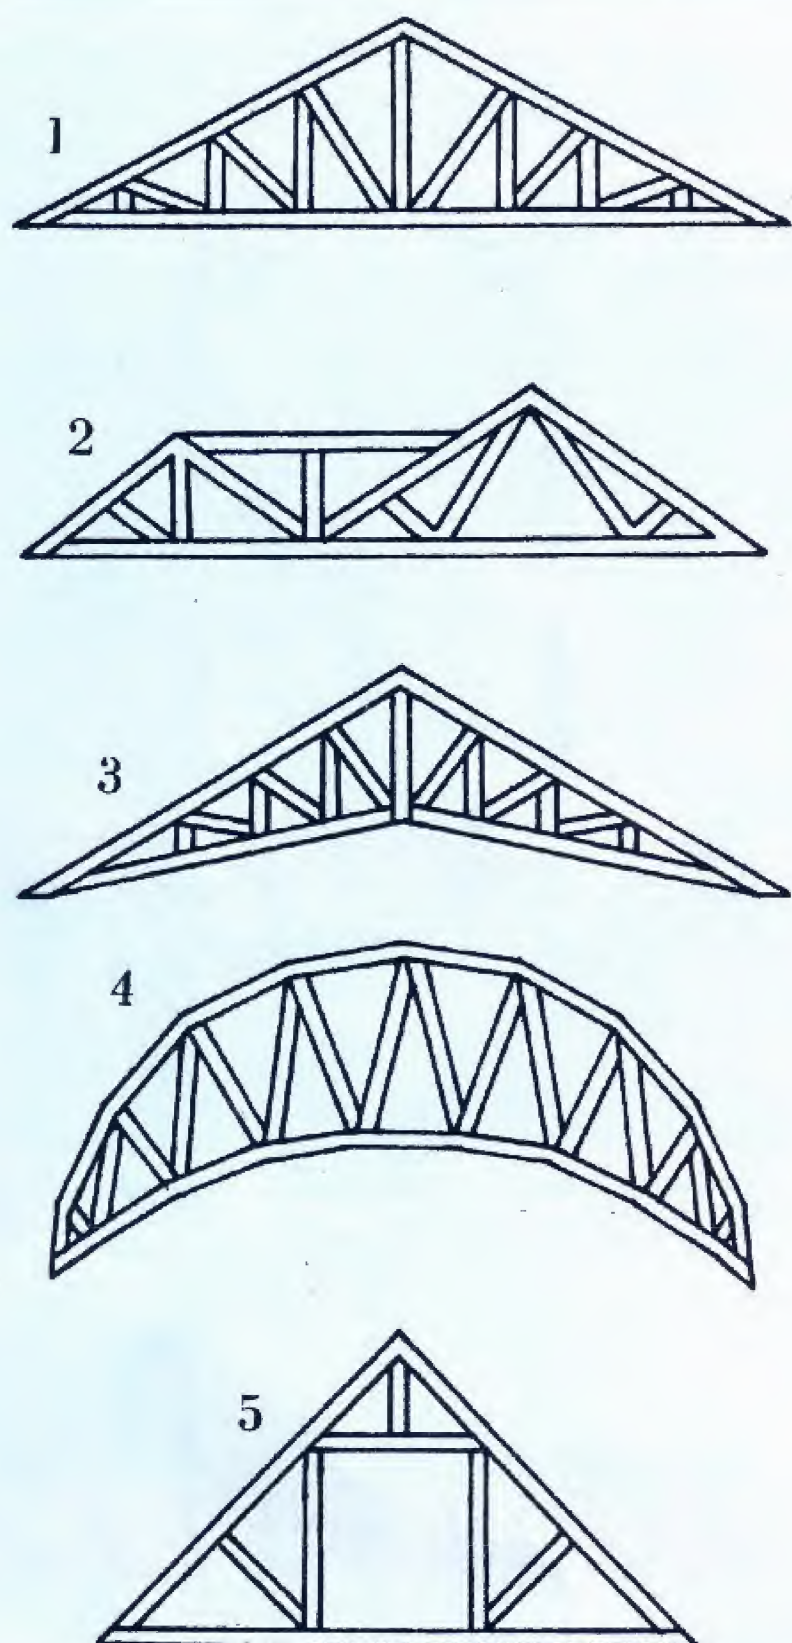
Конструкції ферм для індивідуальних будинків: 1 – двоскатна ферма; 2 – ферма зі складною формою верхнього пояса; 3 – ферма-ножиці; 4 – аркова ферма; 5 – мансардна ферма.
